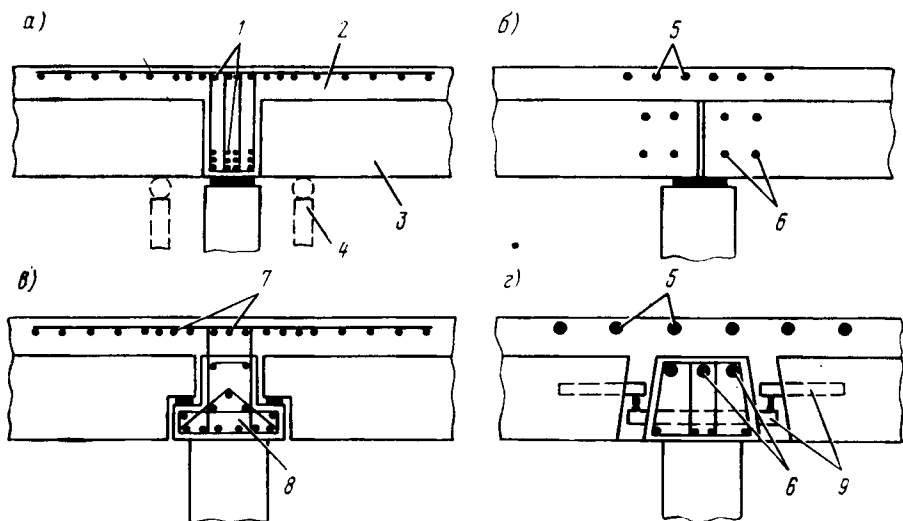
Схемы поперечного армирования в надопорной части сборно-монокрипных плитных пролетных строений:
